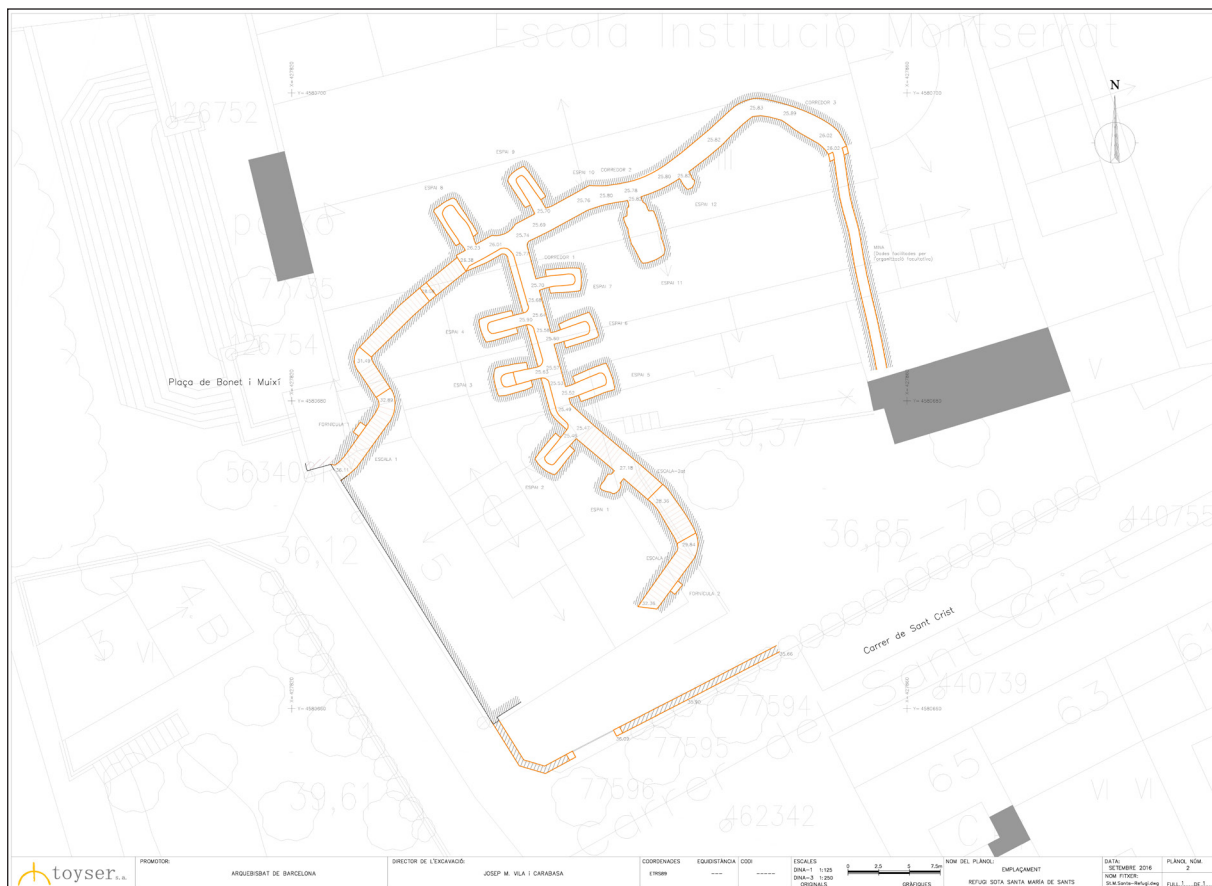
Planimetria del refugi antiaeri número 0819 de la plaça de Bonet i Muixí (Autor: Josep M. Vila).
